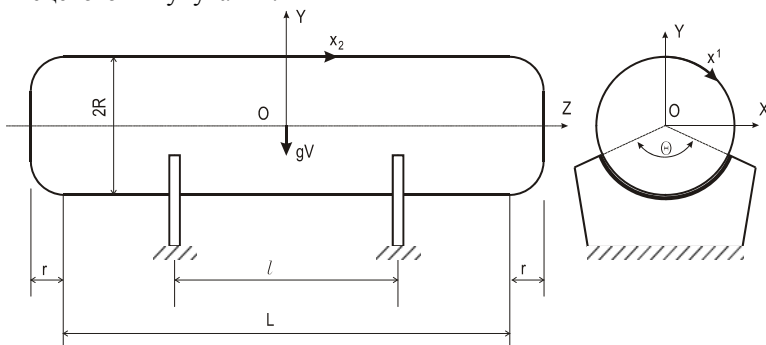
Розрахункова схема горизонтального циліндричного резервуара з еліптичними кришками
